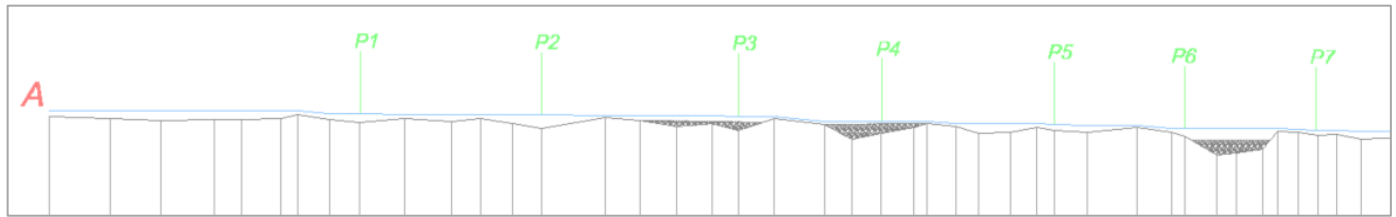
Interventions ponctuelles sur le profil en long en état projet
